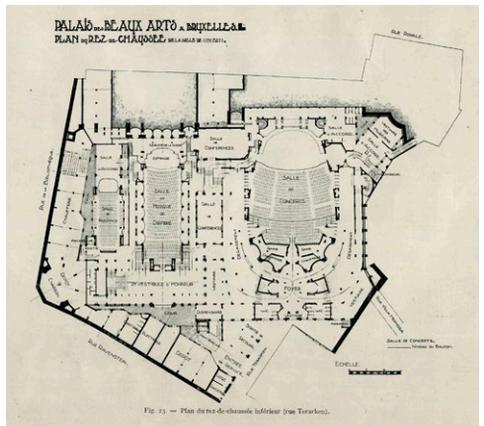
Plan de rez-de-chaussée inférieur (rue Terarken).
